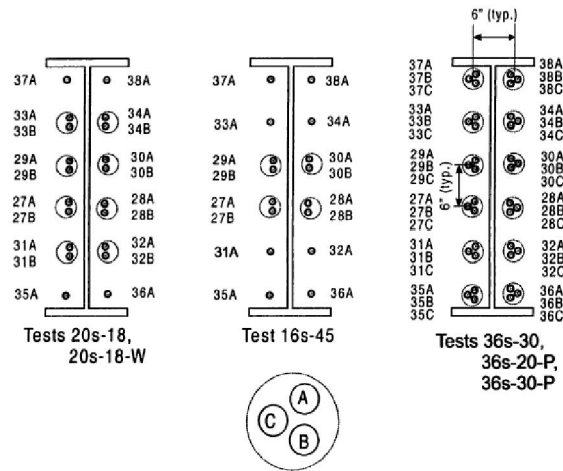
Configuración de perforaciones para traspaso de cables en columnas [4].
